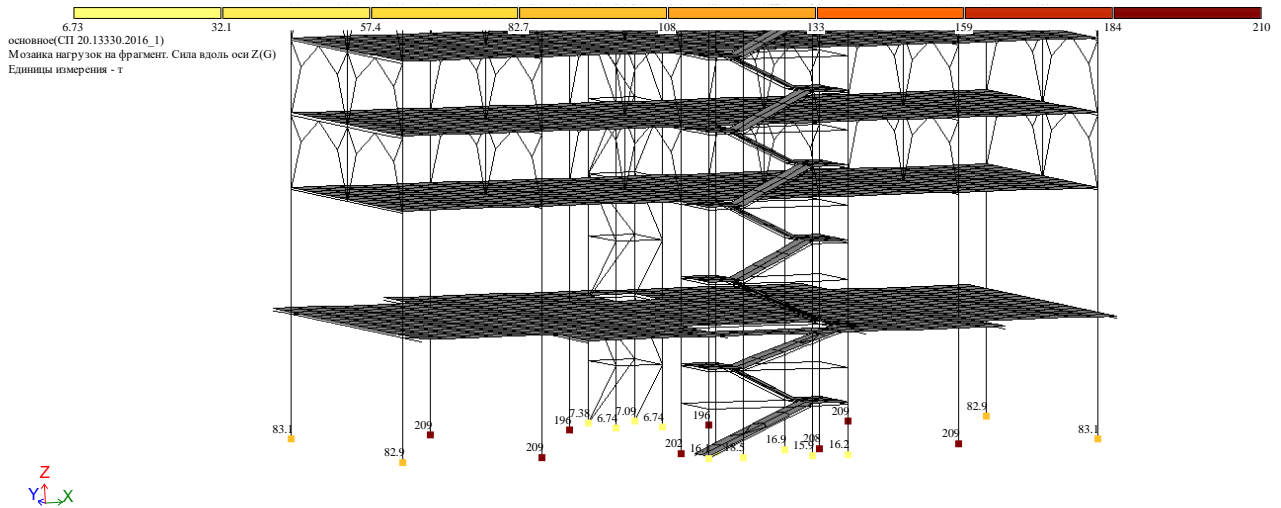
Вертикальная нагрузка от вышележащих конструкций на фундаменты
